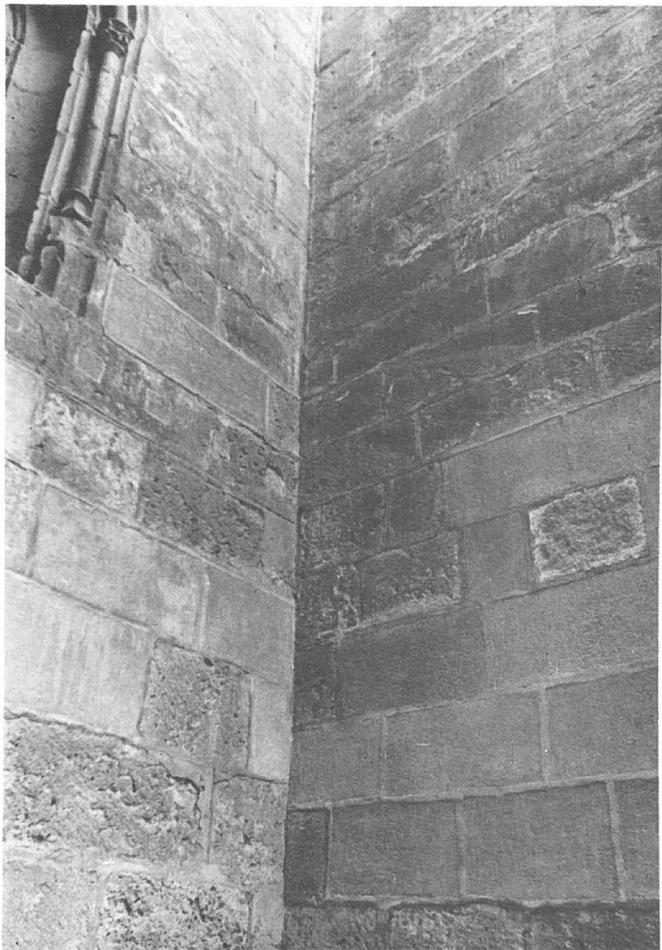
Aparejo del encuentro del muro de la portada y muro primitivo.
